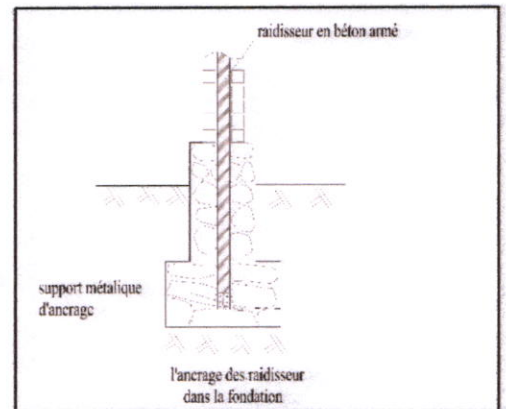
Rattachement des murs avec fondation (Source : auteur)
